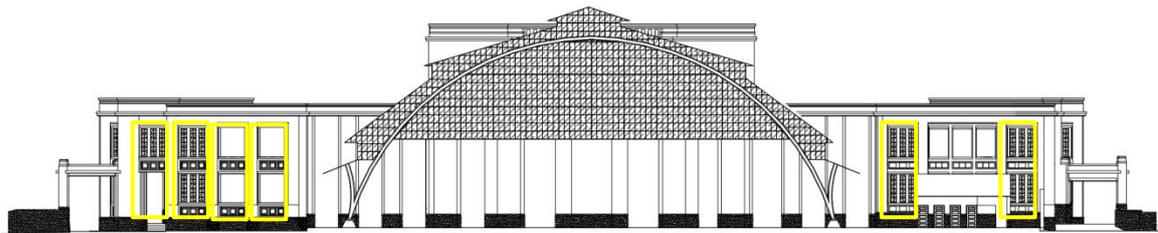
41 Kondisi Eksisting Bangunan Tahun 2017
